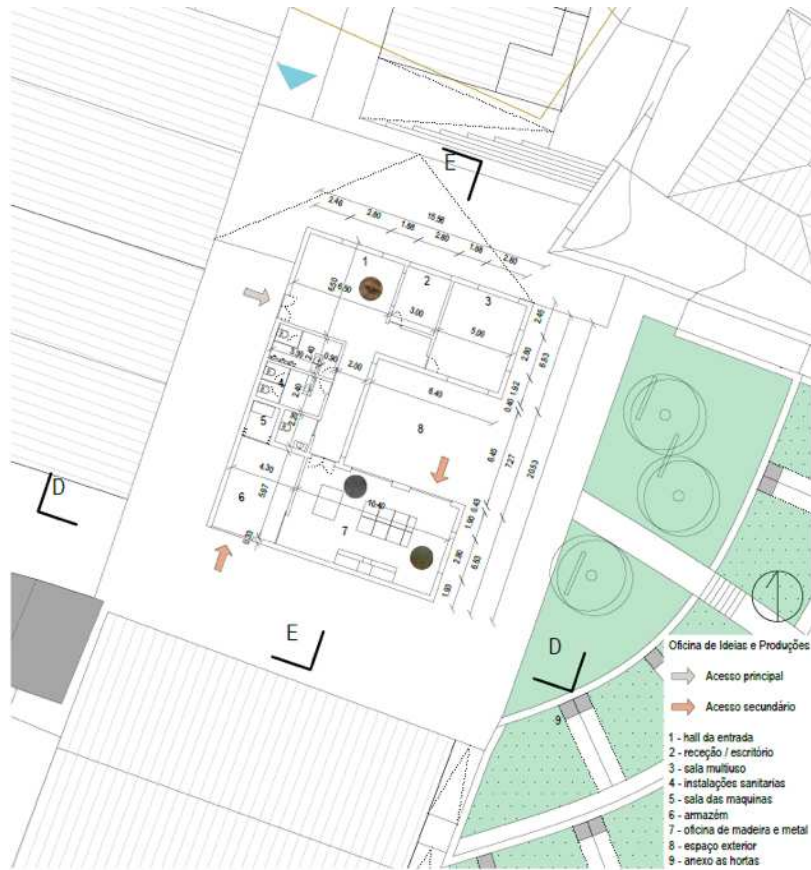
Área de implantação e alçados da proposta de projeto, com a indicação do tipo de pavimentação
